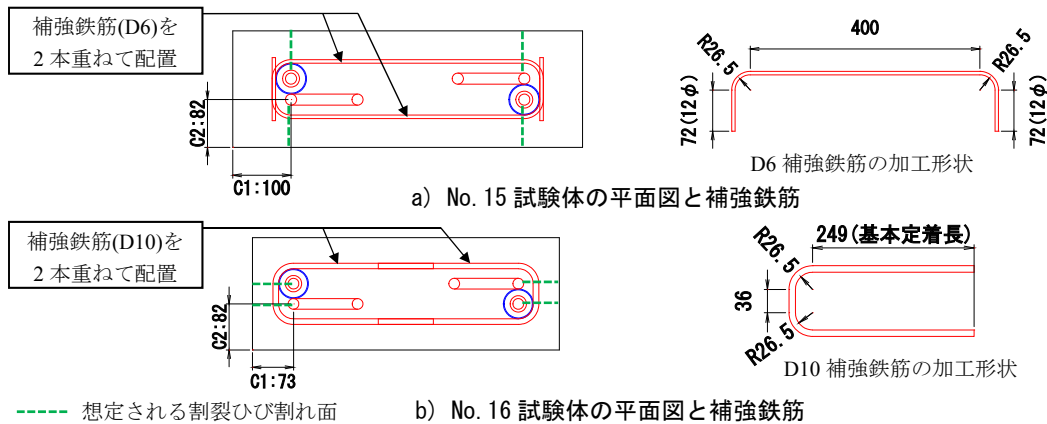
補強鉄筋と想定されるひび割れ面の位置関係
